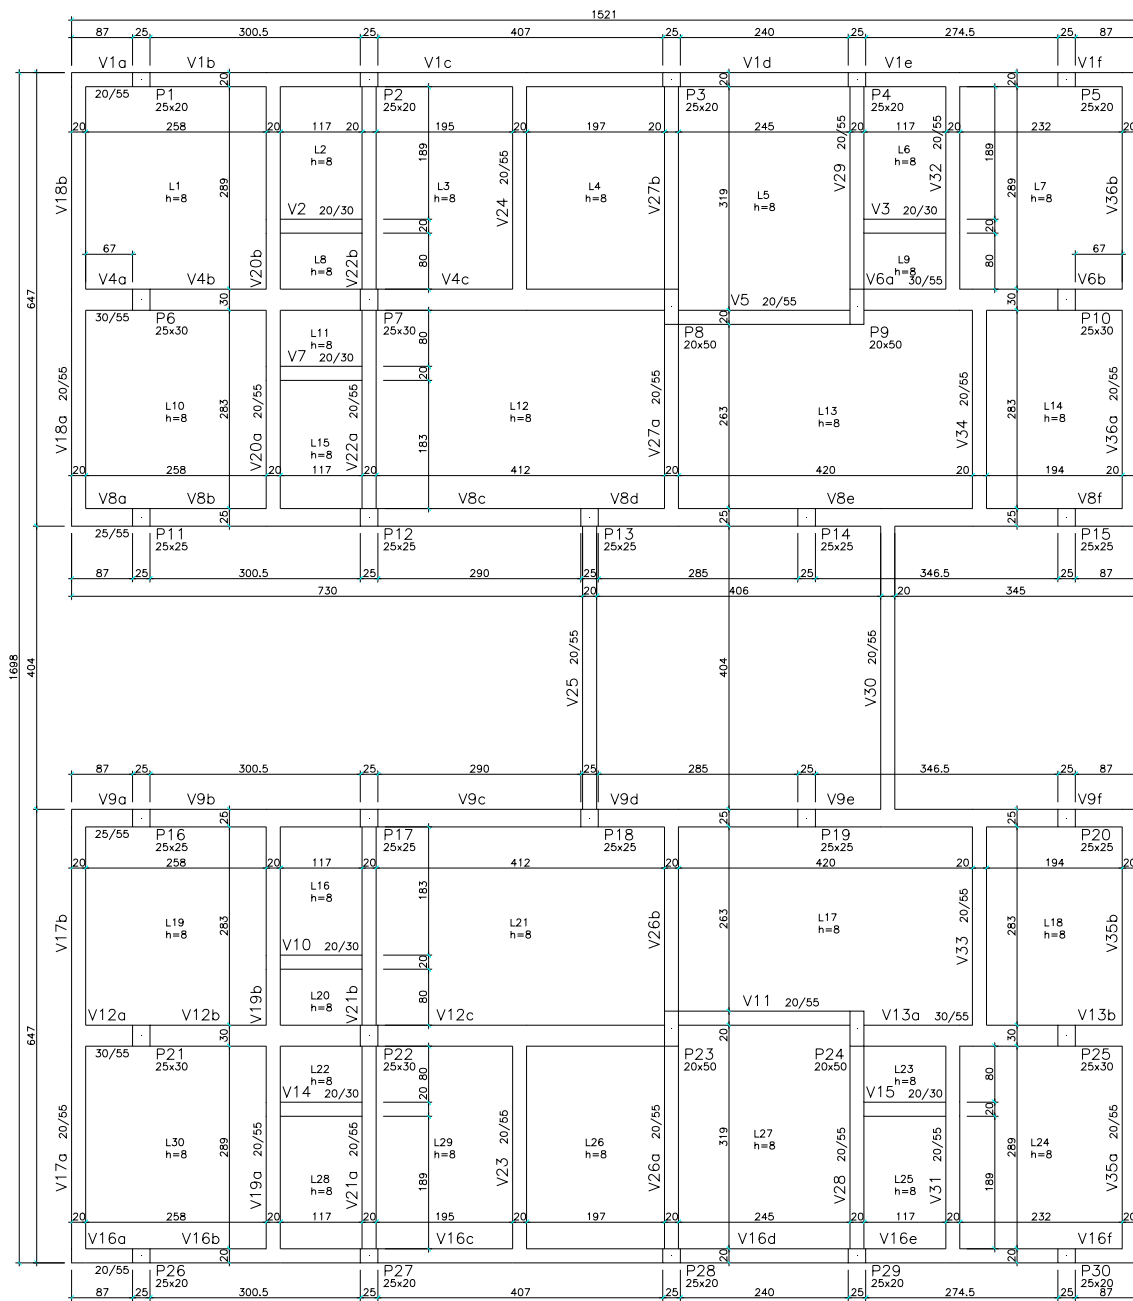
Prédio “A” – Fôrma da Opção 1
